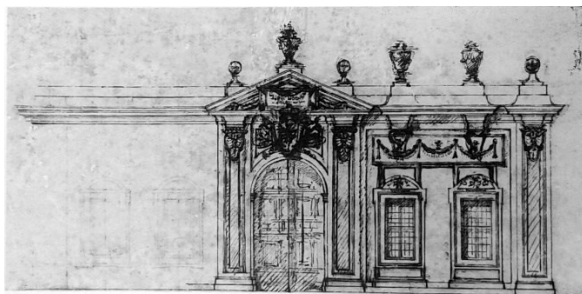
G. B. Piranesi, Prospetto della Piazza di Santa Maria del Priorato sull'Aventino (Roma), 1764-1766
